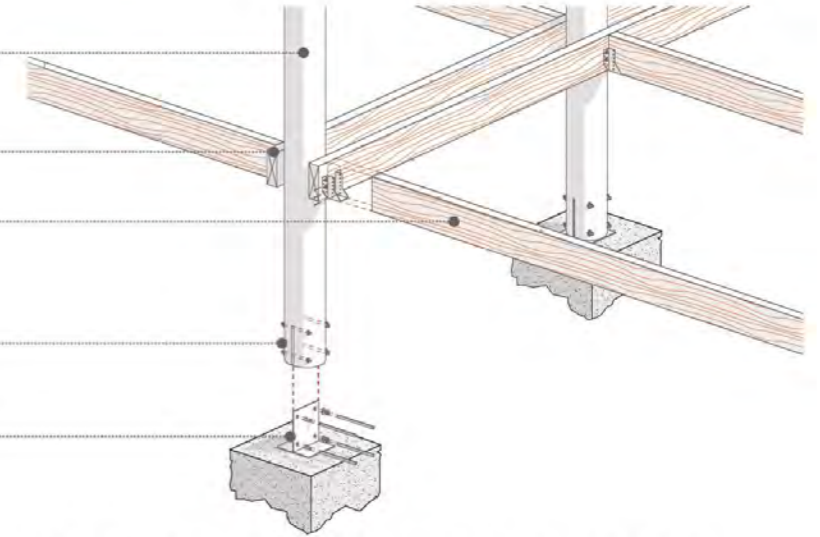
Détail d'assemblage de la structure surélevée, portée par les poteaux
